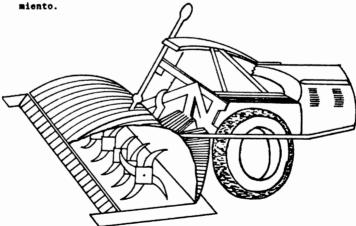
Equipo mezclador de suelo pulverizado y estabilizantes.
